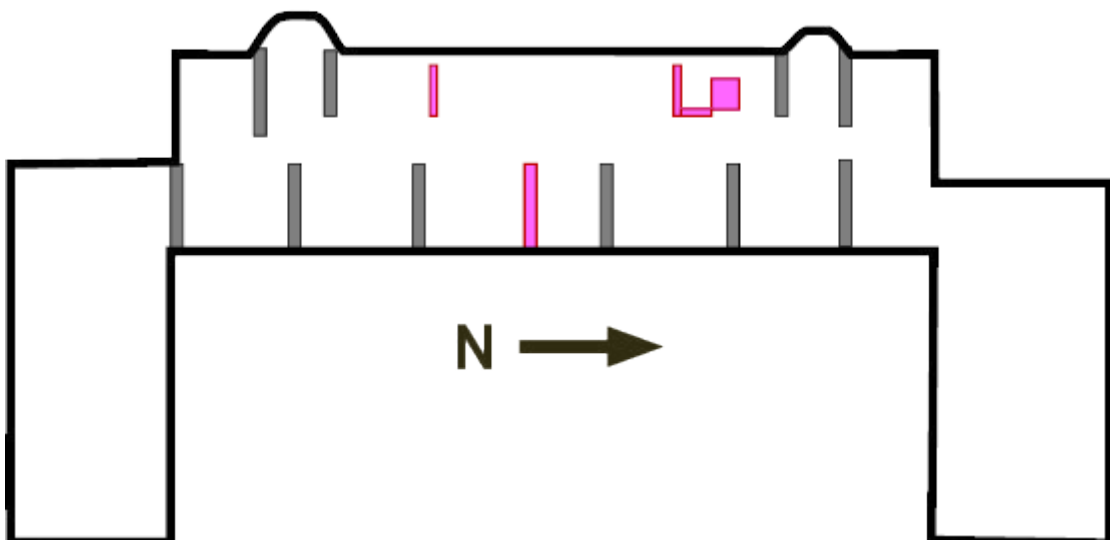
Konzept 2 (pink) im Erdgeschossgrundriss
